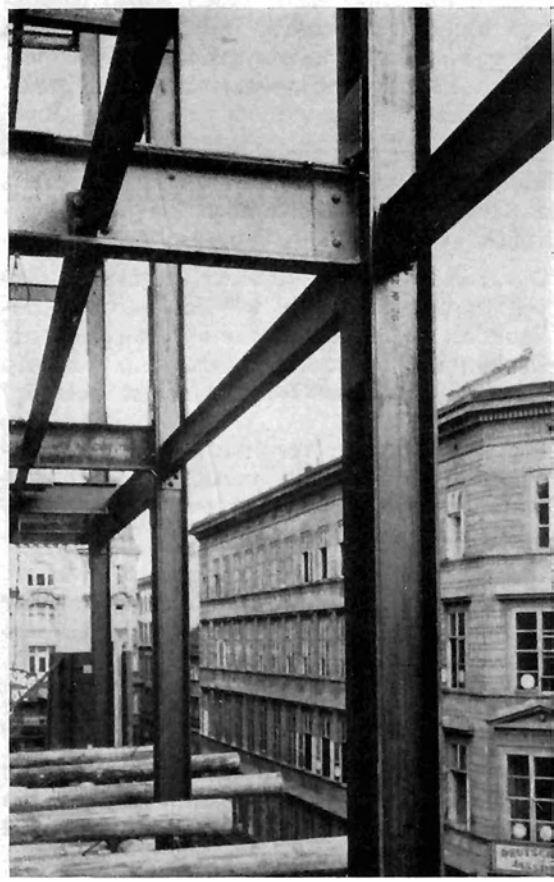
Wiener Stahlskelettgebäude aus dem Jahre 1930
